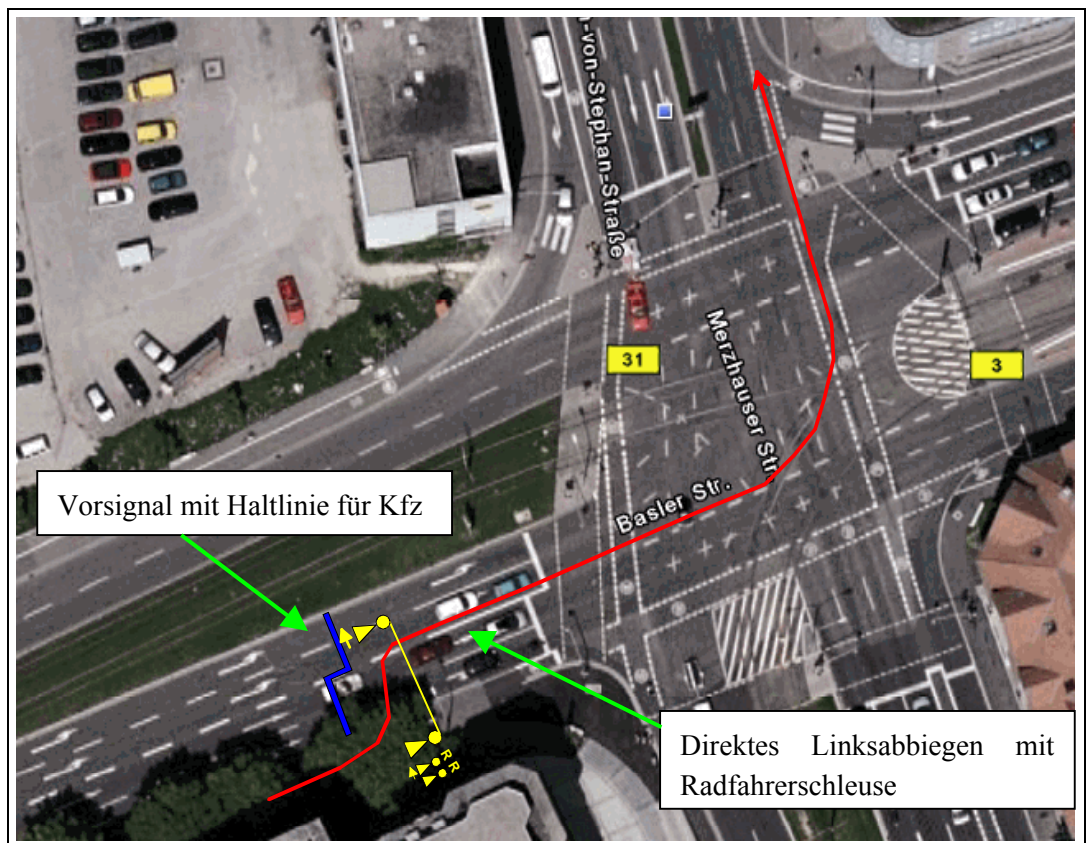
Radfahrschleuse am Knoten Basler Straße – Heinrich-von-Stephan-Straße
